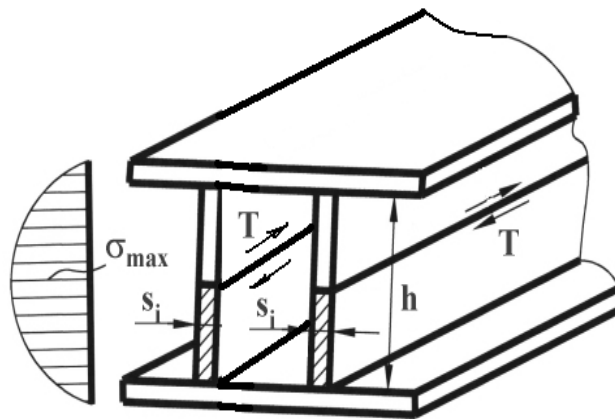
Fuerza de corte en las almas de la viga en alma doble
